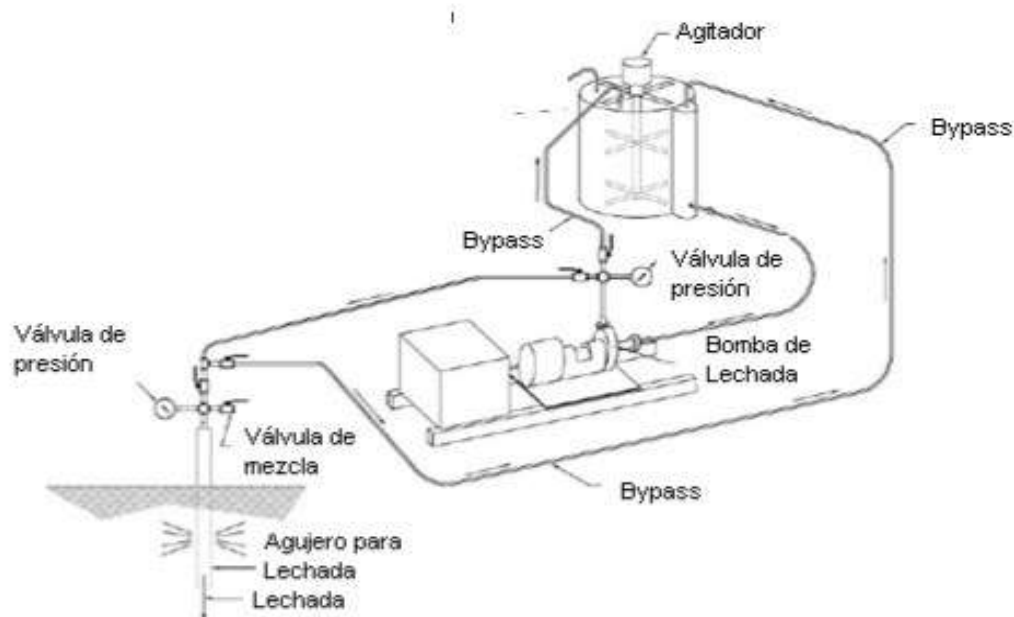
Equipo utilizada en el Jet Grouting. Fuente. Suarez (1988). Ingeniera de suelos aplicada a la cimentación (p. 80)
